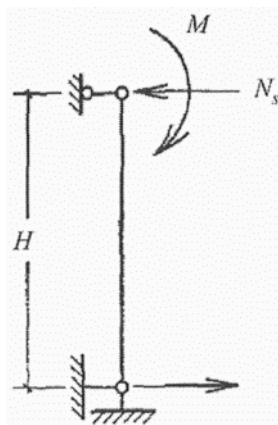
Определение усилия в анкере от изгибающего момента в уровне перекрытия
